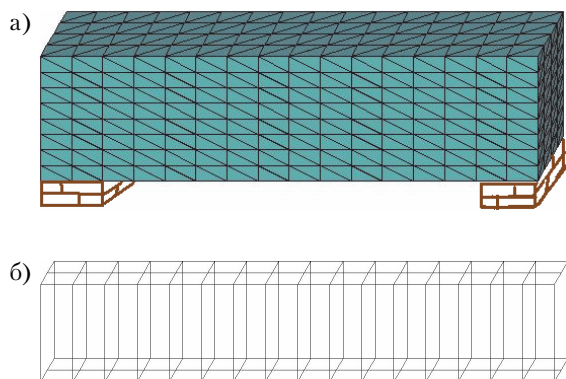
Расчетная модель поэтажного пояса: а) конечно-элементная модель; б) схема армирования поэтажного пояса.
